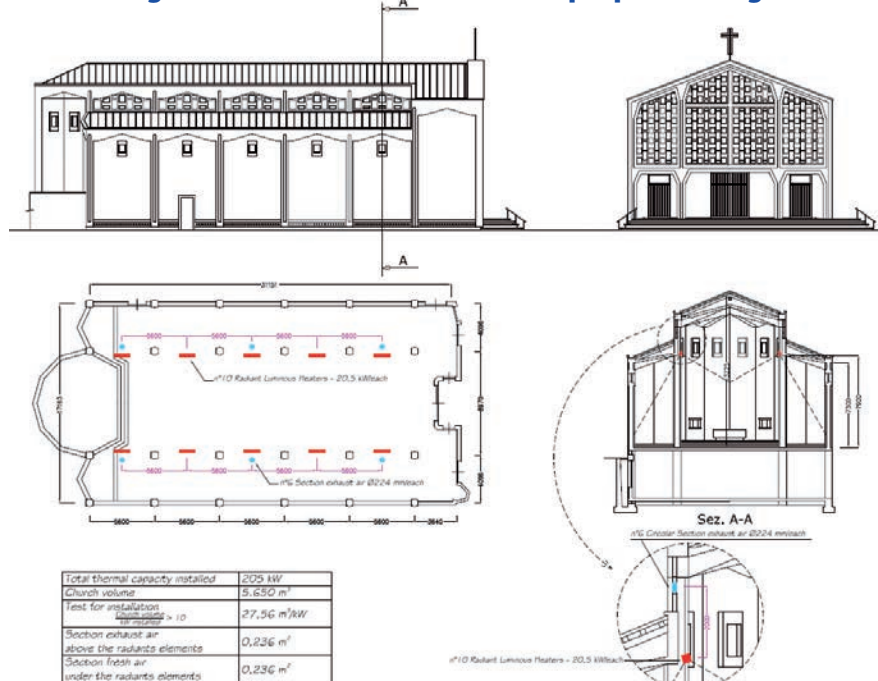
Vista in sezione e in pianta di un sistema di riscaldamento radiante a gas e del sistema di ventilazione proposto in Figura 6
